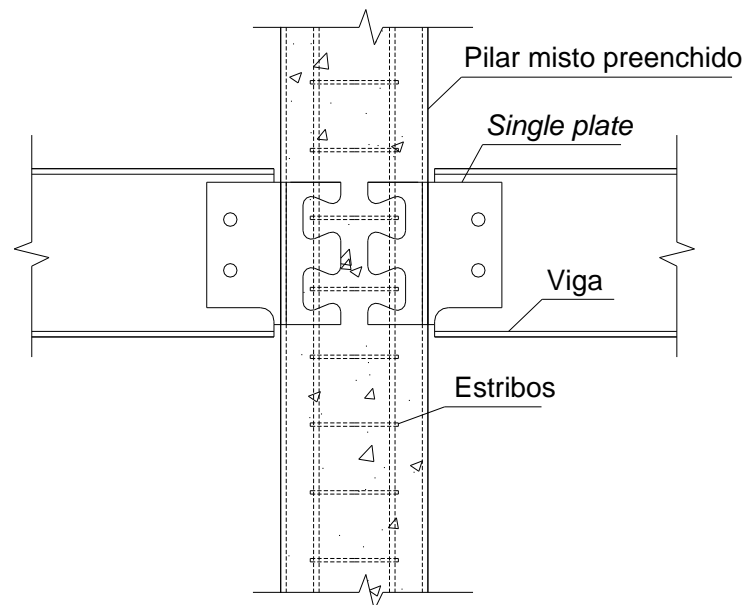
Proposta de Utilização do Crestbond em Pilares Mistos Tubulares Preenchidos com Concreto (Aguiar, 2015)
